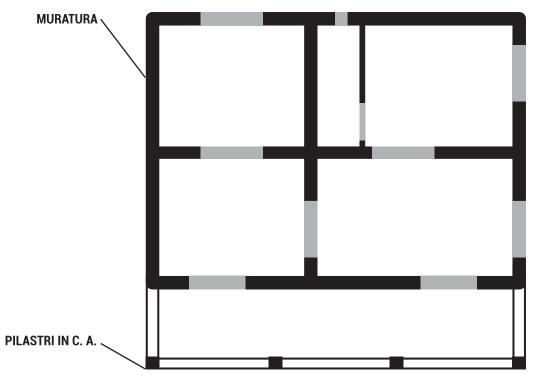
Esempio di struttura mista con muratura perimetrale e pilastri esterni.
